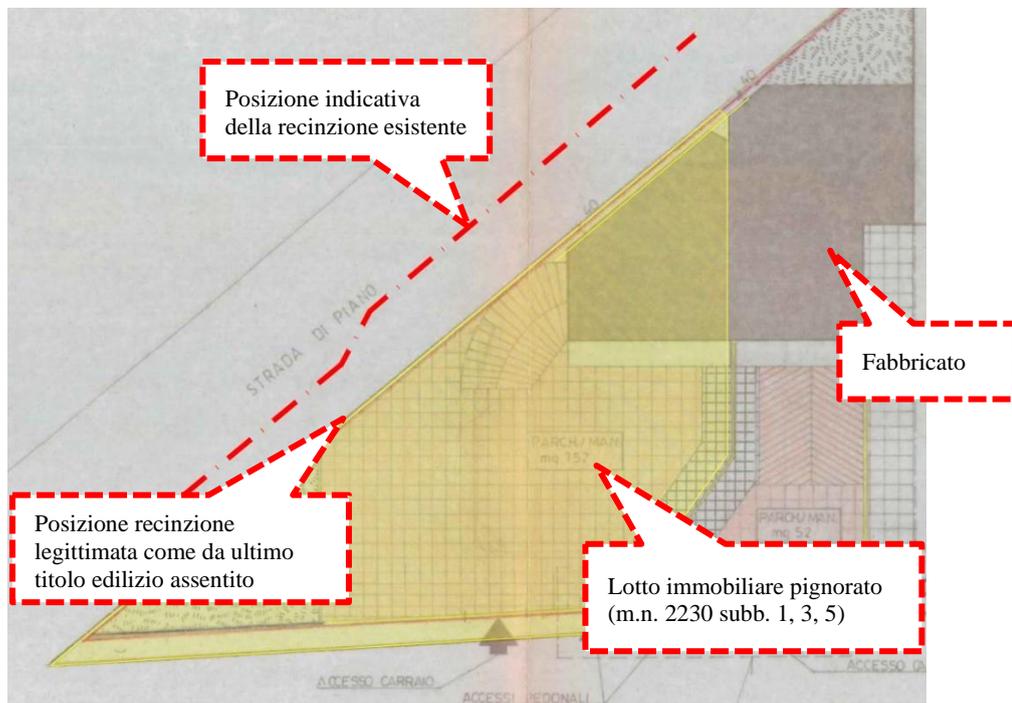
Estratto planimetria assentita con indicazione dell'attuale posizione indicativa della recinzione
